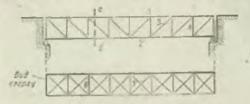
Схемя пролетного строения железнодорожного моста со склозными (решетчатыми) фермами для езды поверху:
